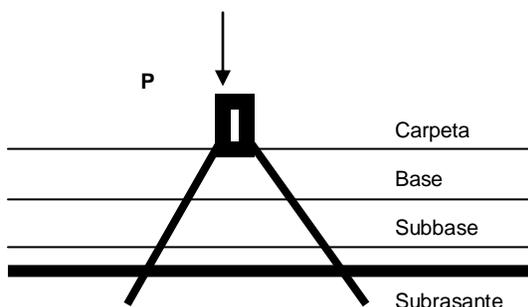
concreto asfáltico. Fuente Apuntes de Construcción FI.
